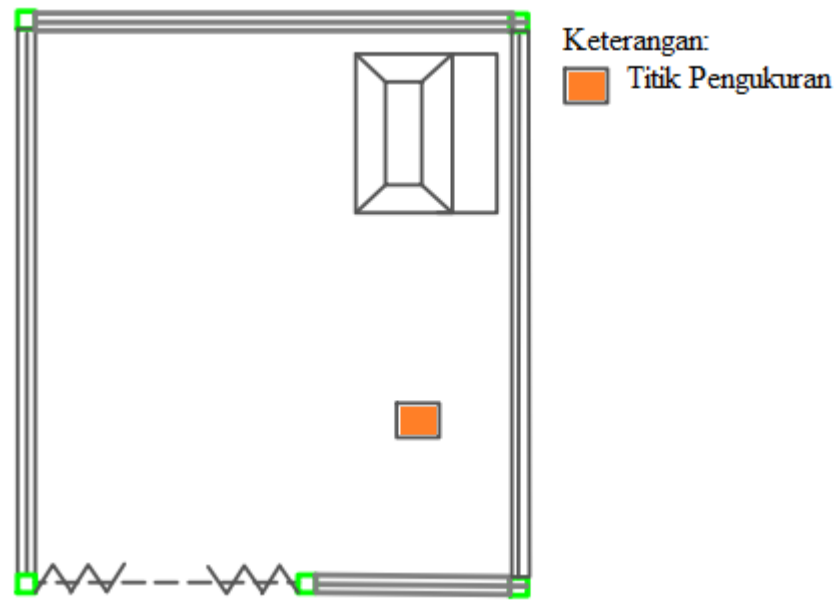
Layout Titik Pengukuran Area Injeksi Plant 01
